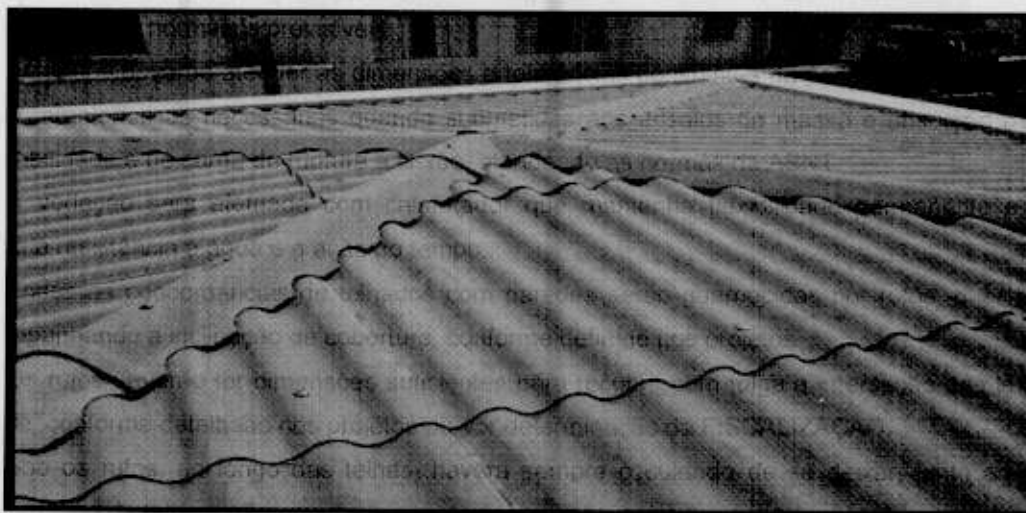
Telhamento em telhas onduladas de fibrocimento 6 mm
